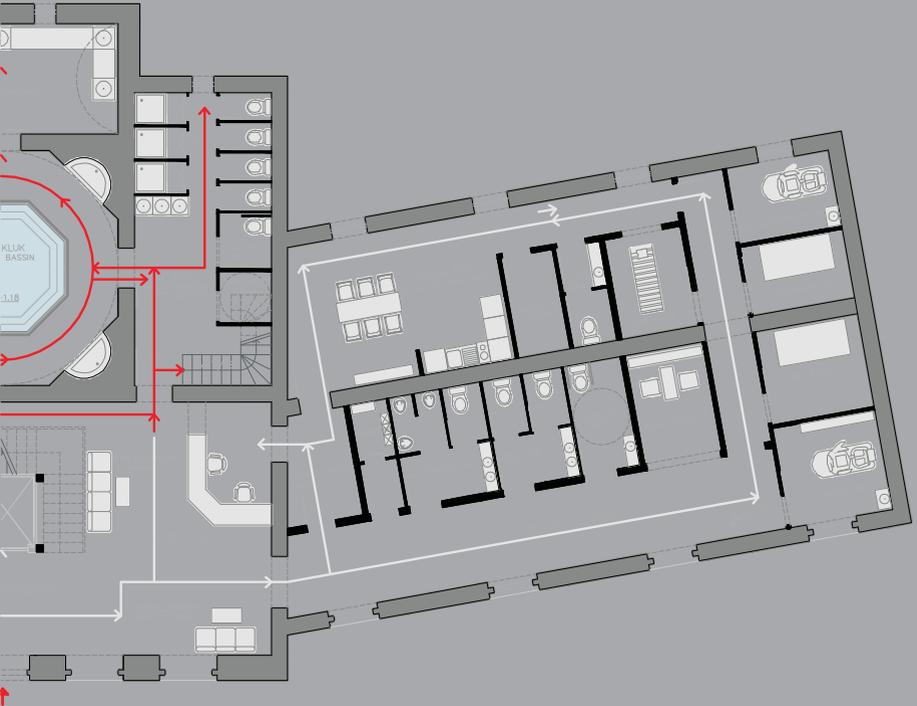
Grundriss Erdgeschoss\_Gehlinie
